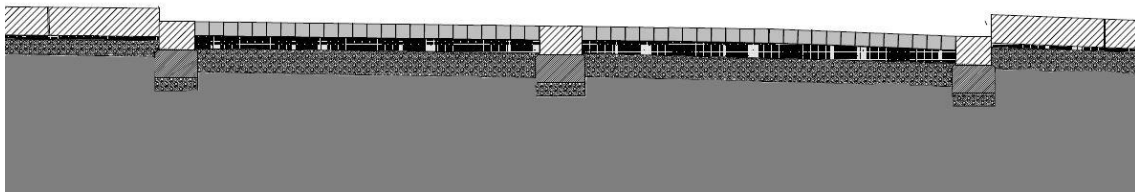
Corte construtivo pavimentos da Rua Largo Ator Dias. Fonte: Autor (sem escala).
